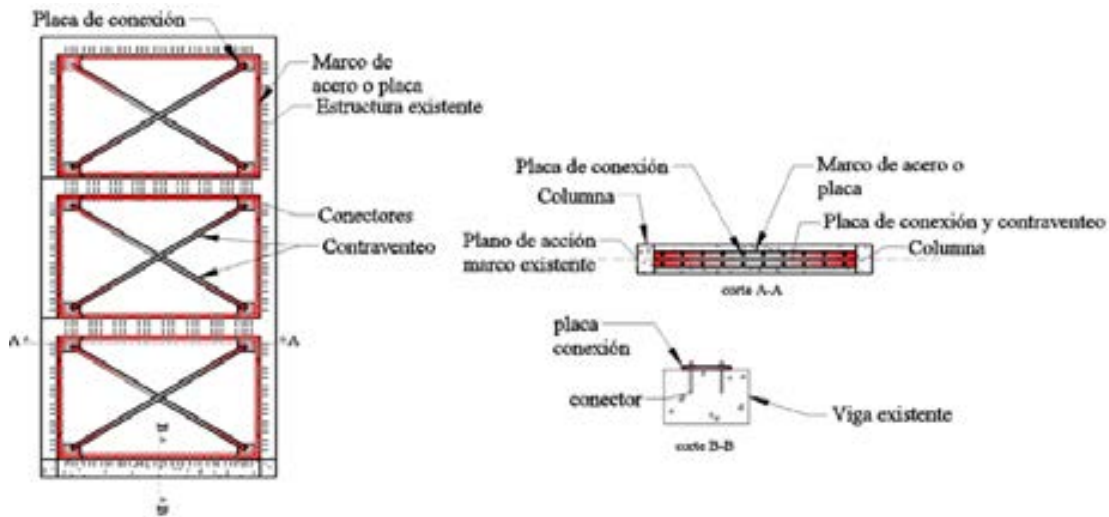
Contraventeos con conexión perimetral al marco
